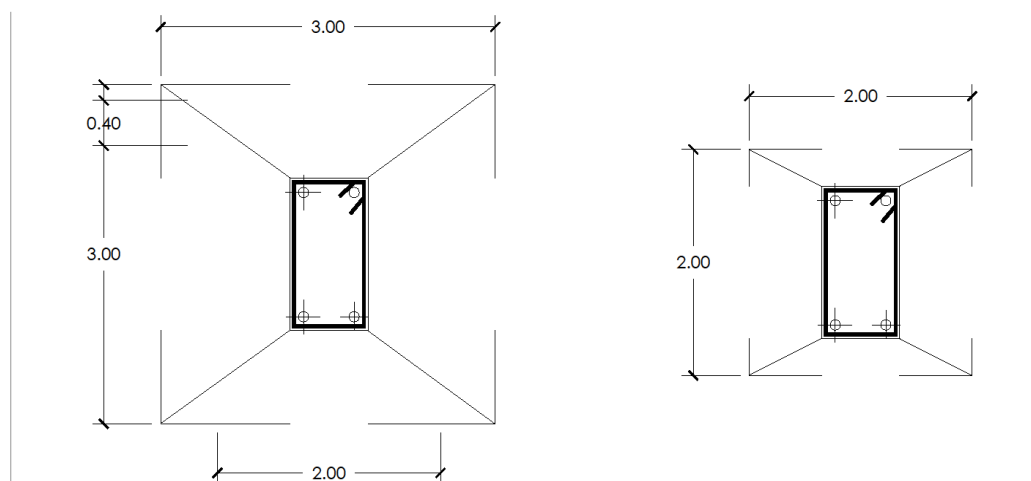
Detalle Zapatas / Fuente Elaboracion Propia
